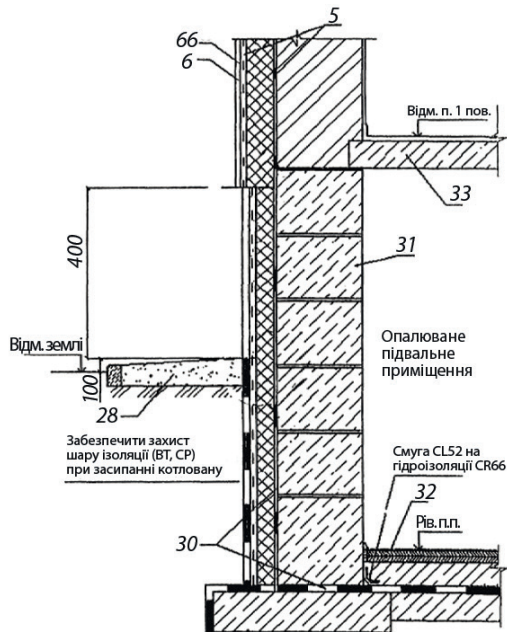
Схема утеплення підвальної частини будівлі з поверхневим стіканням дощової води:
